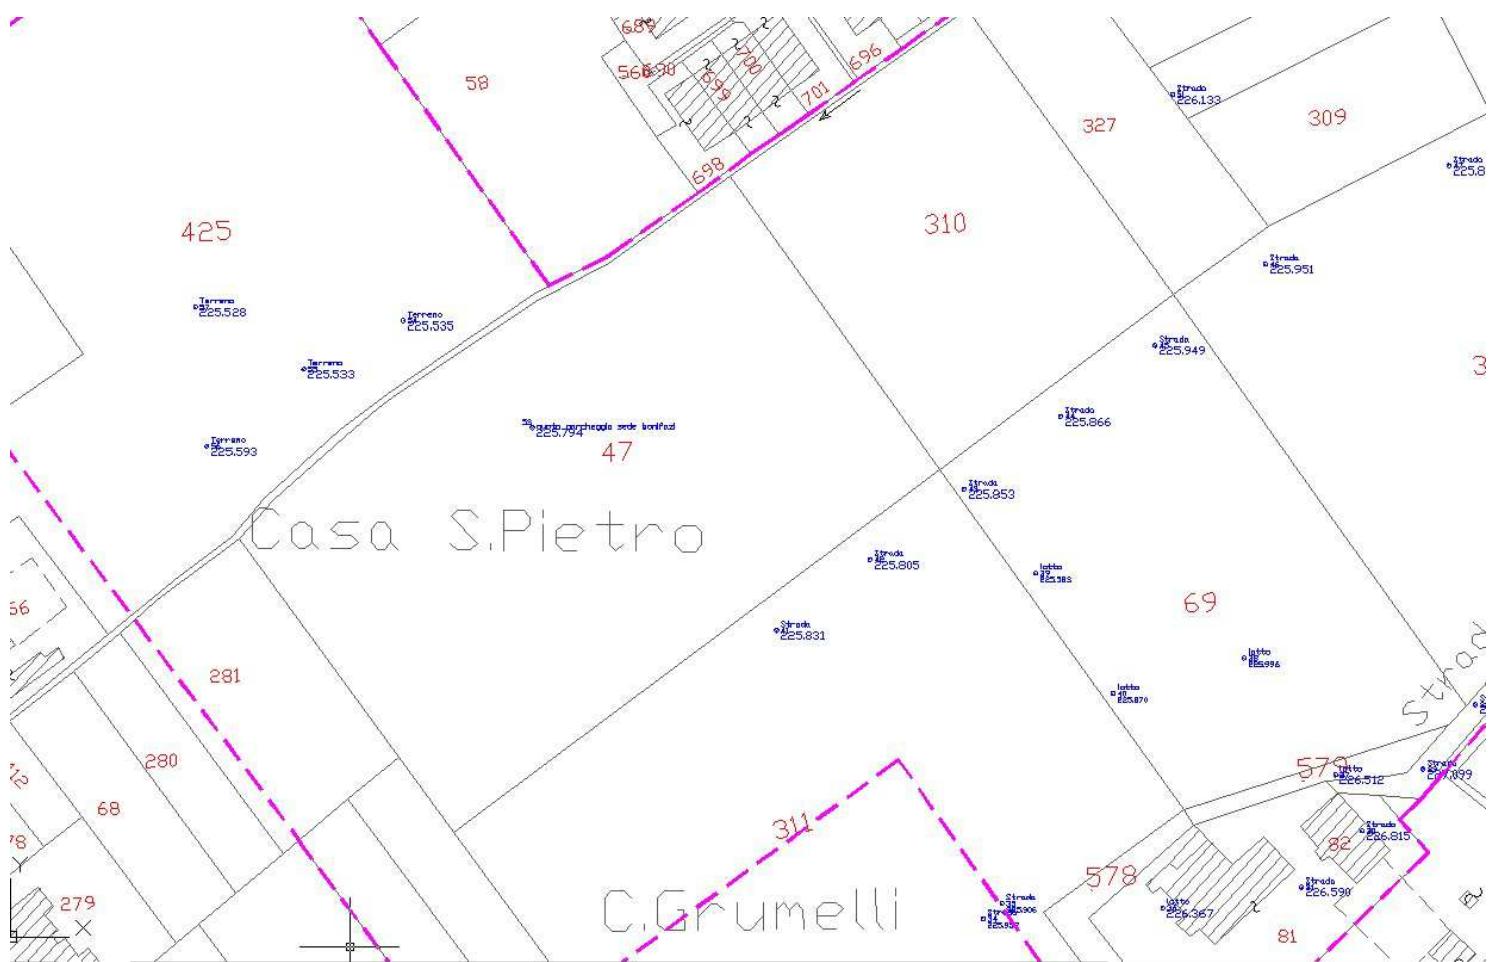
Planimetria generale dello Stato dei luoghi su planimetria catastale con inserimento dei punti del rilievo battuto - Zoom A -
